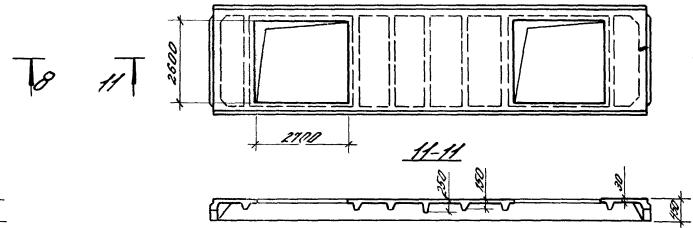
Плита типоразмера 278.12 с двумя просеками для зенитных фонарей
